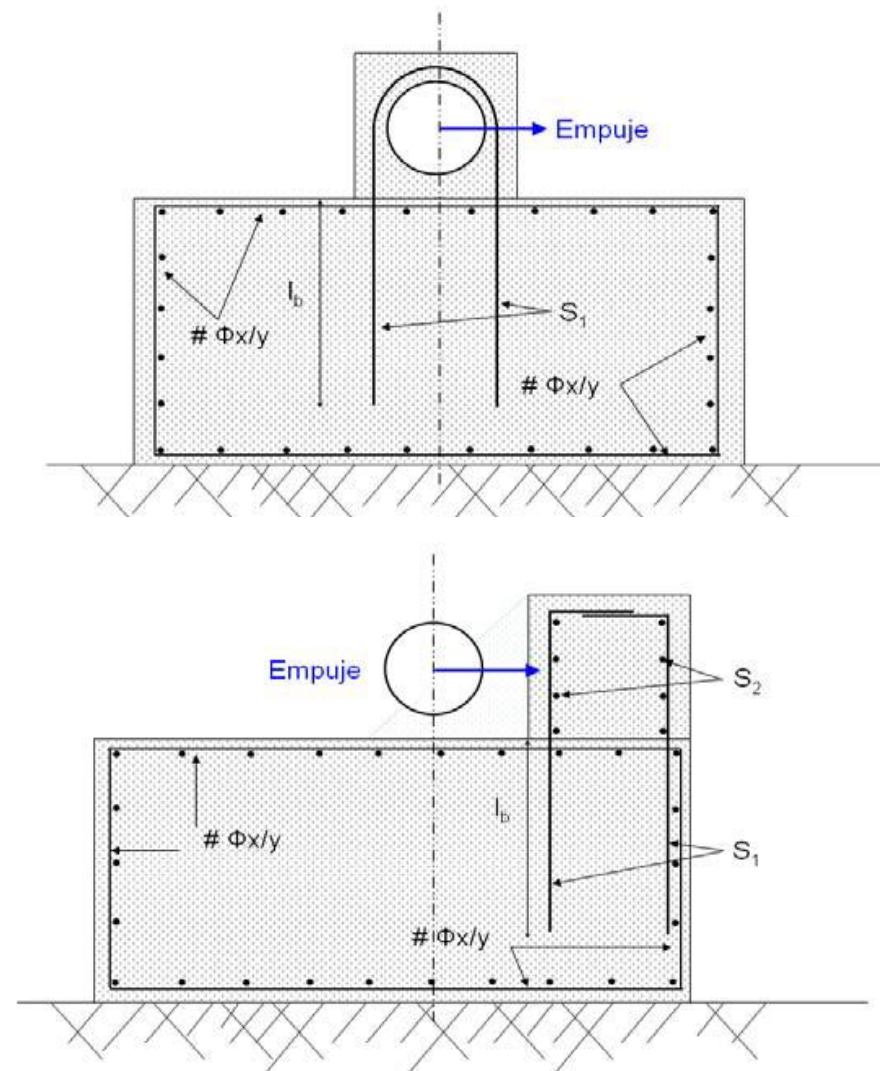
Esquema Cálculo Armado en Macizos de Anclaje
